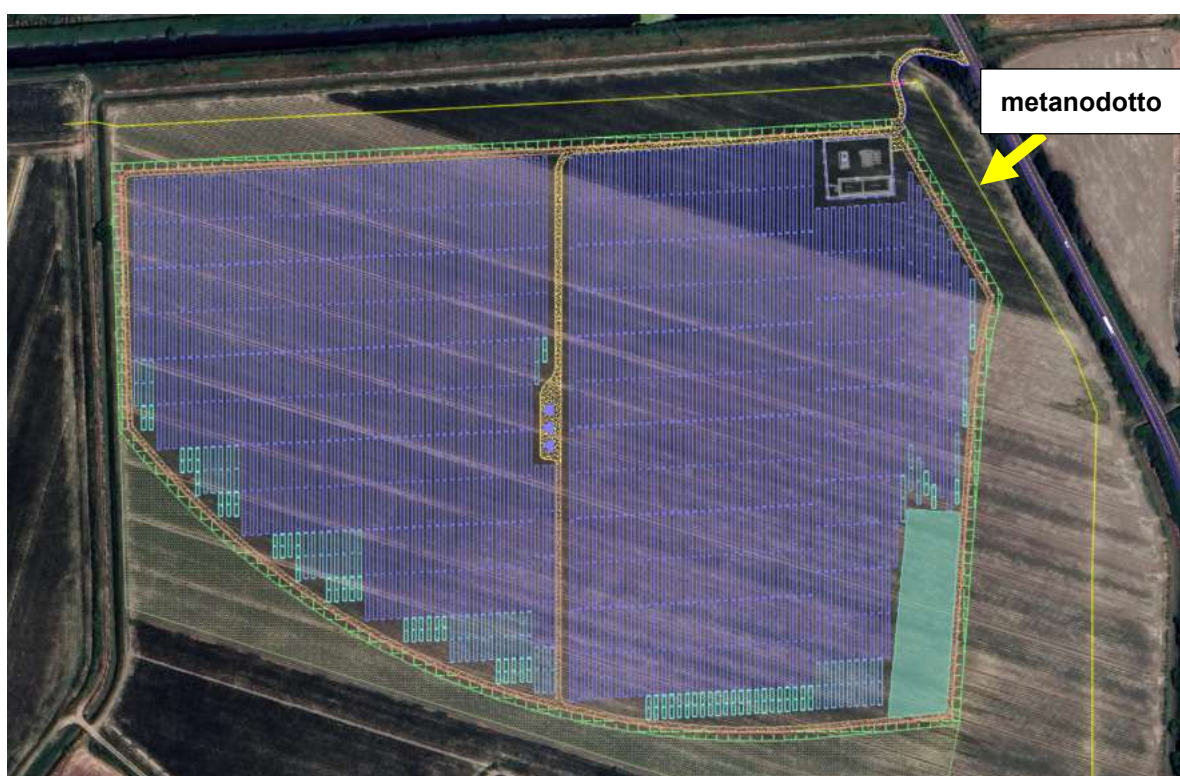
Sovrapposizione del layout di impianto con metanodotto SNAM
